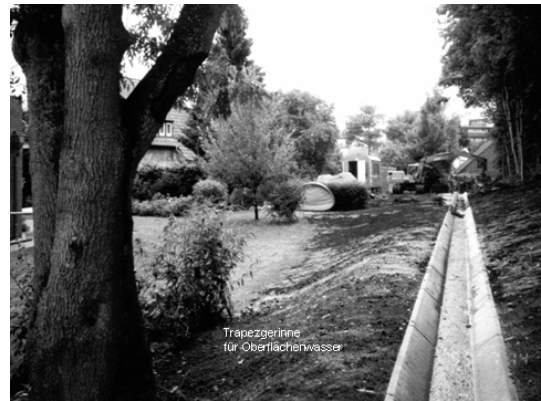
Auffangen des Oberflächenwassers über eine Betonrinne
